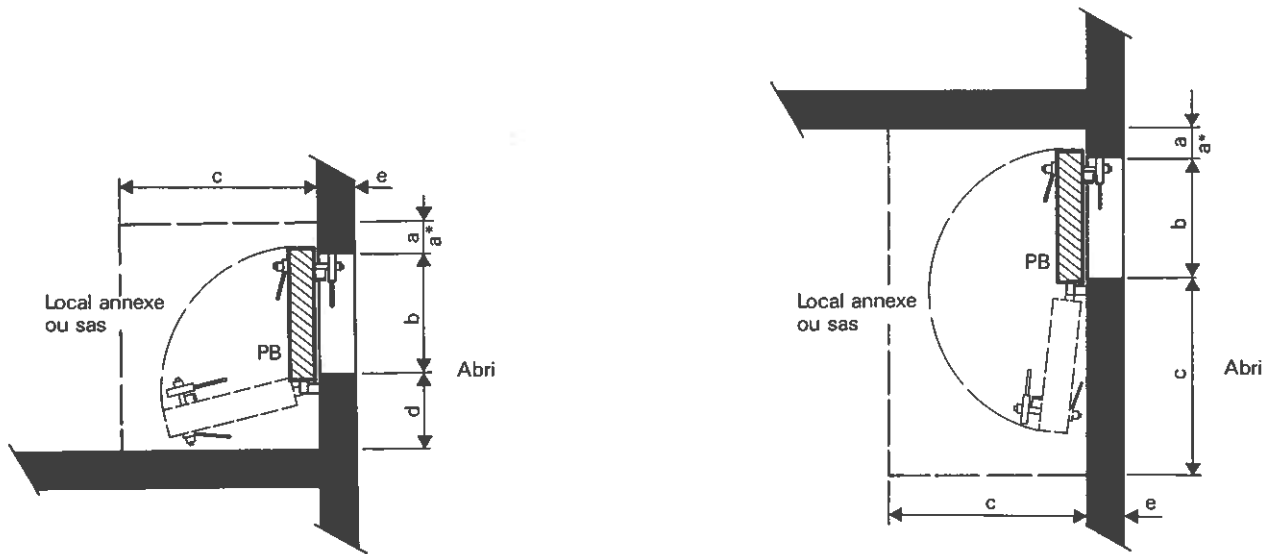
Disposition d'une porte normale près d'une porte blindée (vue en plan)
